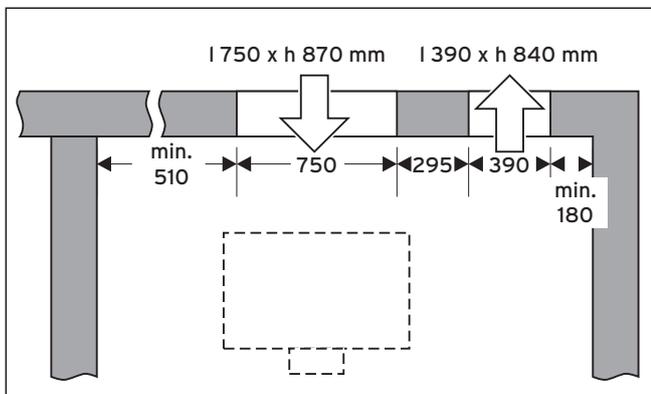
Installation sur un mur, sortie d'air à droite
